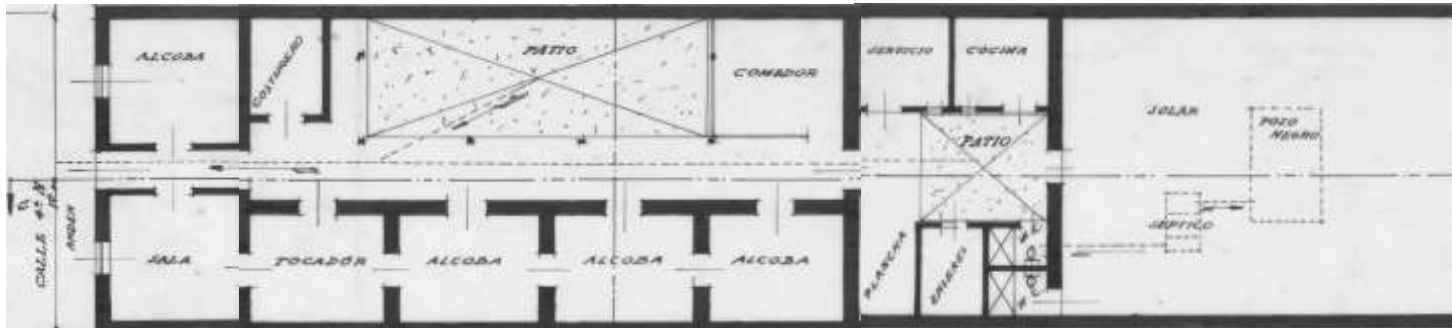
Planta dividida en dos partes de la vivienda del Sr. Ernesto Lloreda, Calle. 4 Carrera. 16-17. Barrio la Mutualidad.
